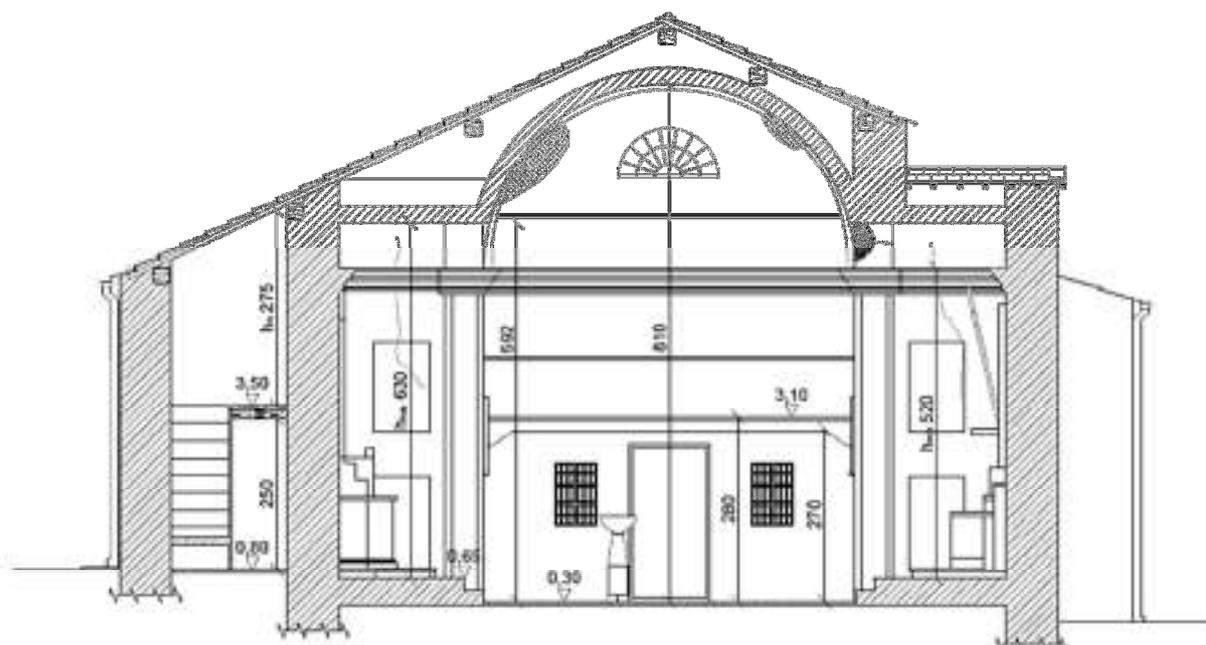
Sezione trasversale B-B (Fonte: Tavola 3E)
